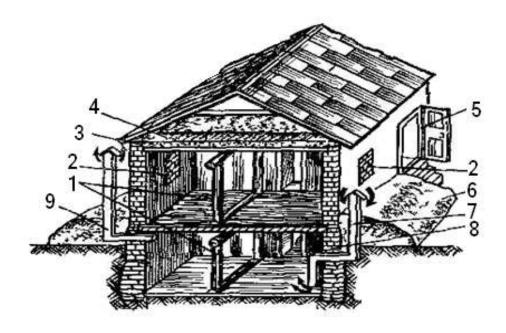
Приспособление подвала каменного дома под укрытие: 1 — рамы усиления перекрытия; 2 — заполнение проема кирпичом; 3 — слой утеплителя; 4 — дополнительная грунтовая подсыпка 30-40 см; 5 — валики для уплотнения притвора двери; 6 — грунтовая обсыпка наружных стен; 7 — приточный короб с матерчатым фильтром и заслонкой; 8 — заполнение проема кирпичом; 9 — вытяжной короб с заслонкой.
